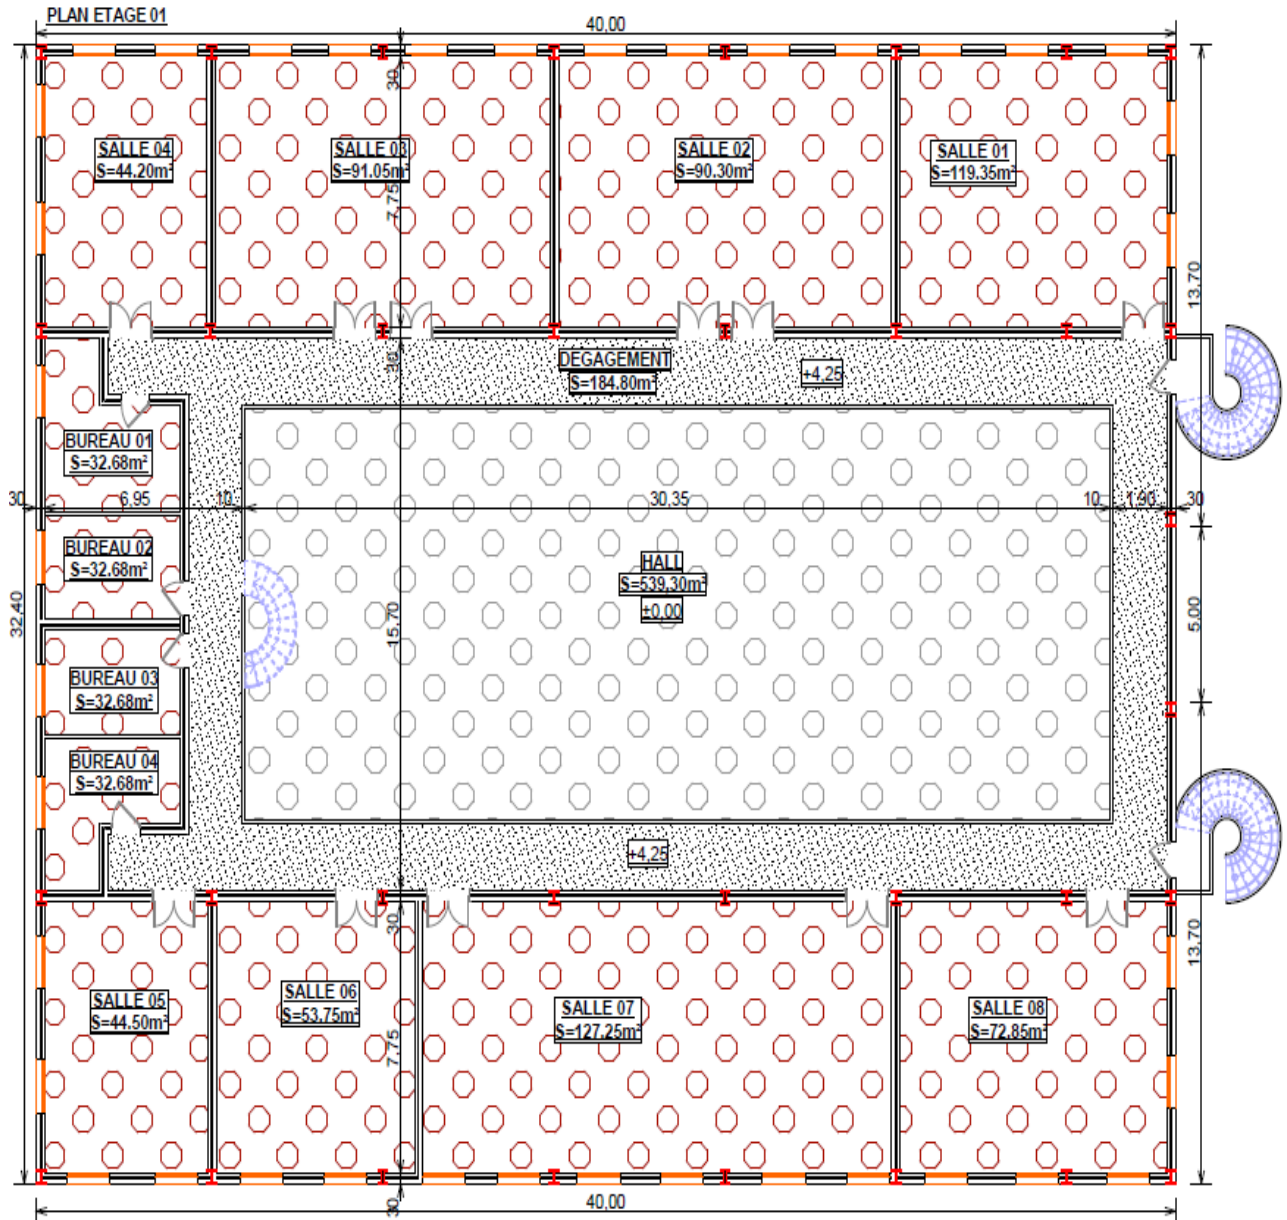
Le plan de 1<sup>er</sup> étage du locale
